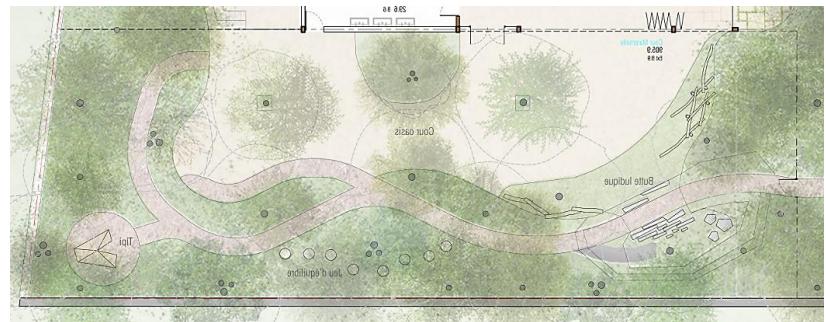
Lageplan des Hofs mit integriertem Grünbereich und natürlichen Materialien (Vurpas Architectes, BASE)
